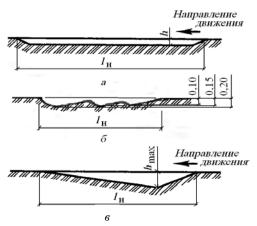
Схемы резания грунта бульдозером: a – прямоугольная; δ – гребенчатая; ϵ – клиновая
